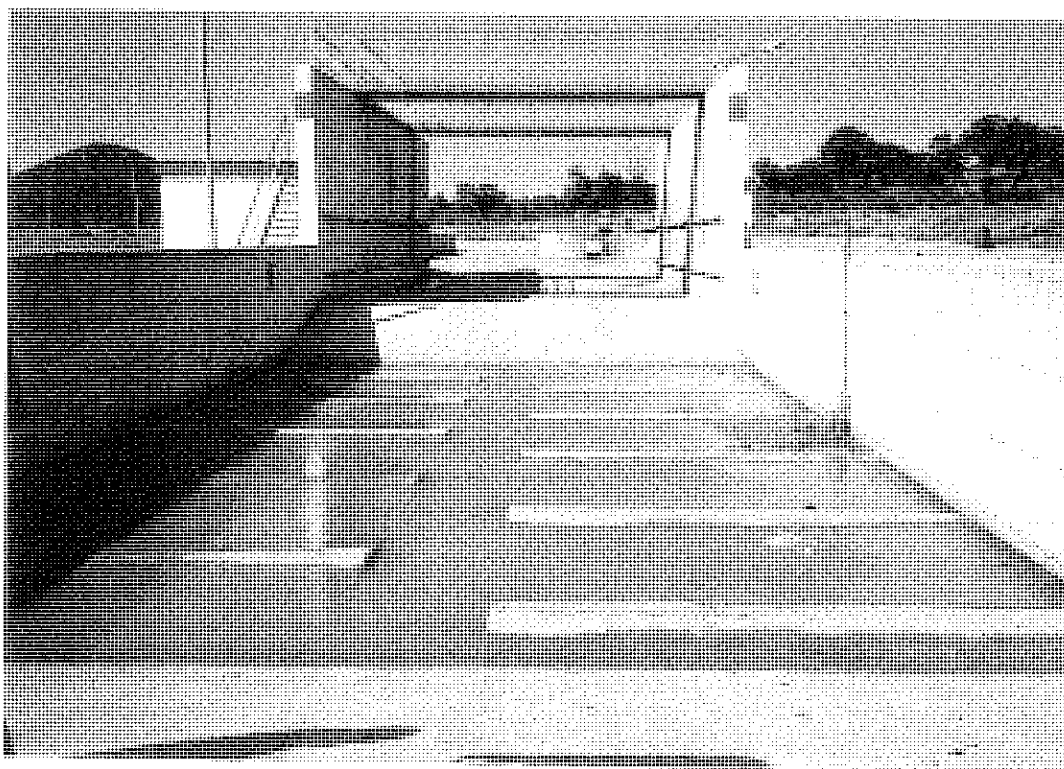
Balsa de lavadero de carros. Cerro Muriano.
